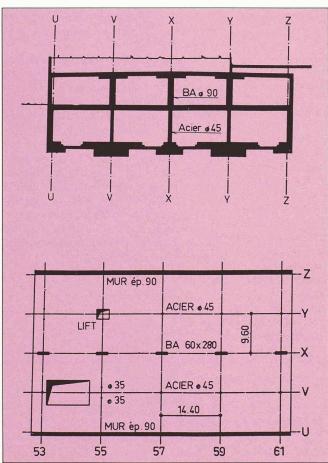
Zone commerciale: coupe (en haut) et plan entre deux joints.
